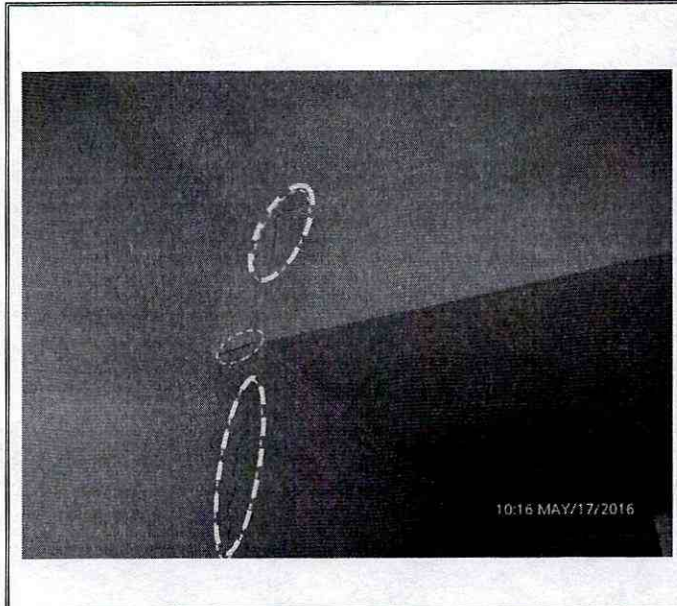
Presencia de grietas, fisuras y fracturas en muros de la parte posterior de la vivienda de la Carrera 91 No. 70B - 10 en el Sector Catastral Los Álamos de la Localidad Engativá
